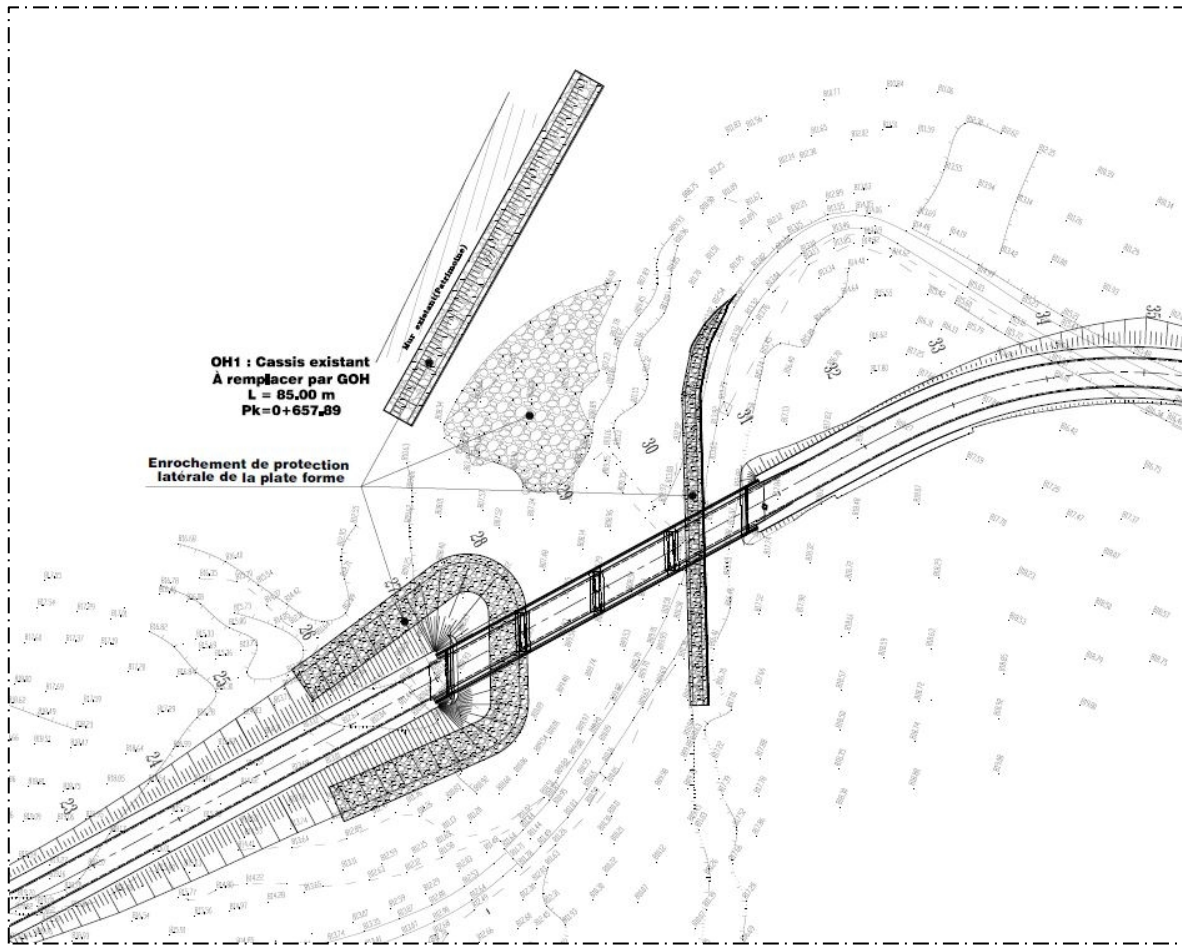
ouvrage proposée pour le franchissement de l'oued Hidra dans le cadre de la variante 2 : Pont à poutre préfabriquées
